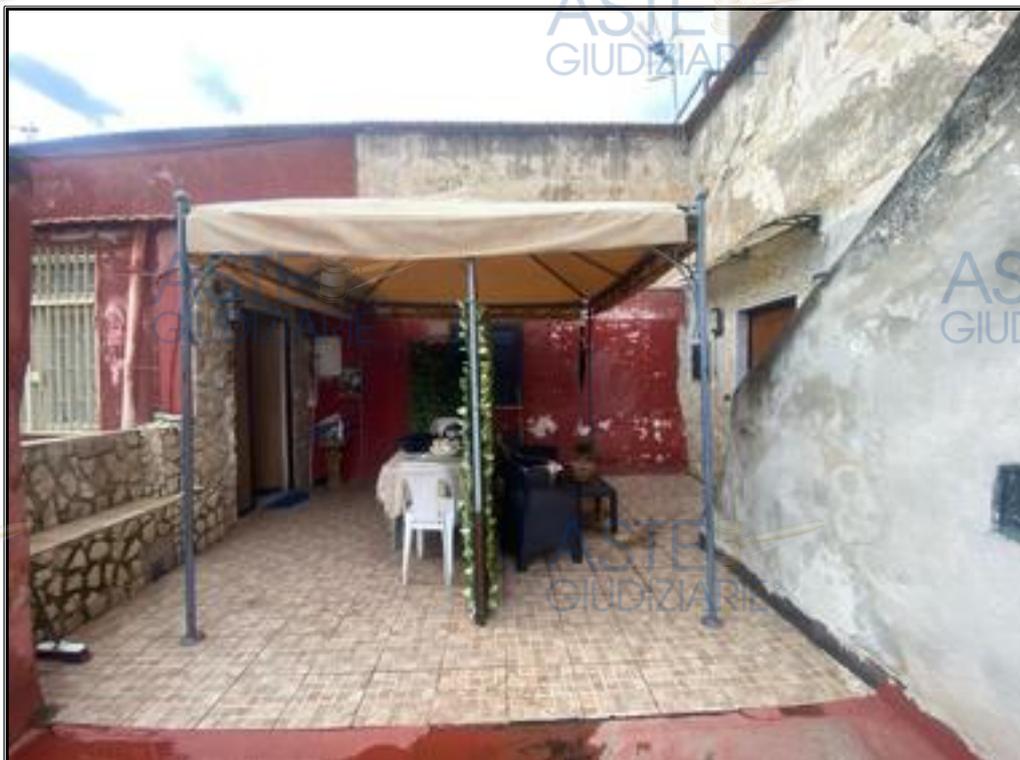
Piano secondo (o terzo oltre l'ammezzato) - Ingresso appartamento
